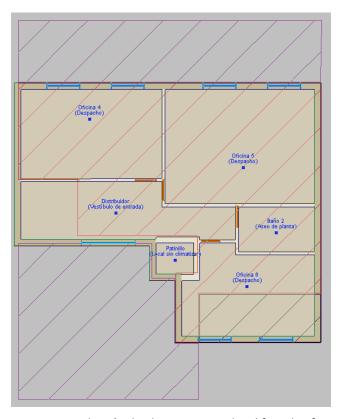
Distribución de planta primera de edificio de oficinas.
